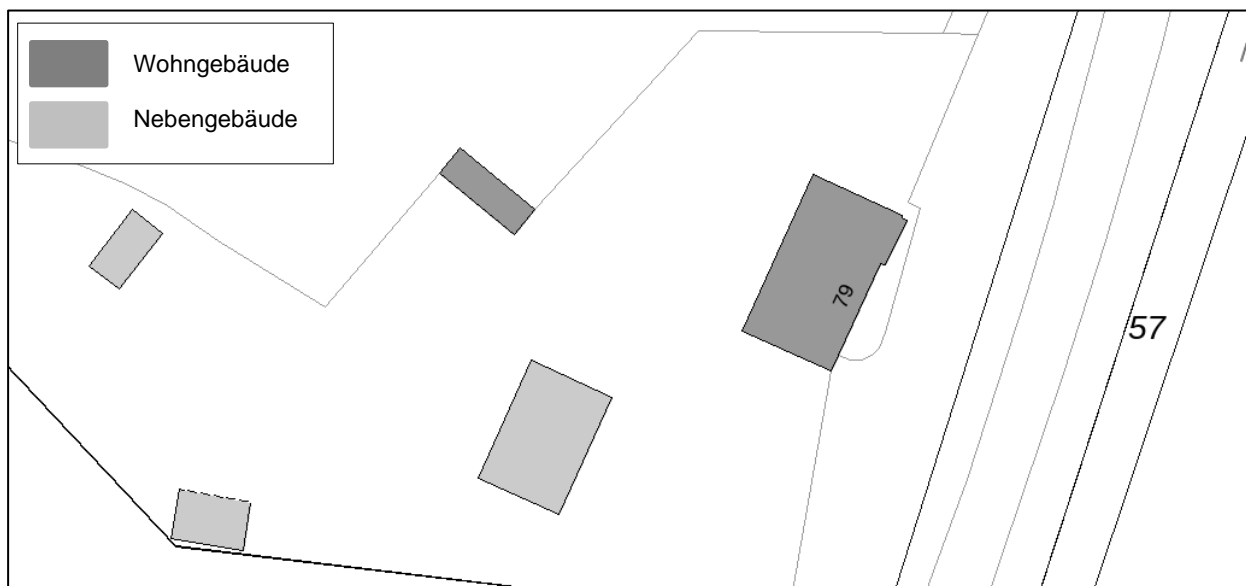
BP7 Wohnhaus ,Delbrück-Steinhorst, Kaunitzer Straße 79' - Lageplan [6]
